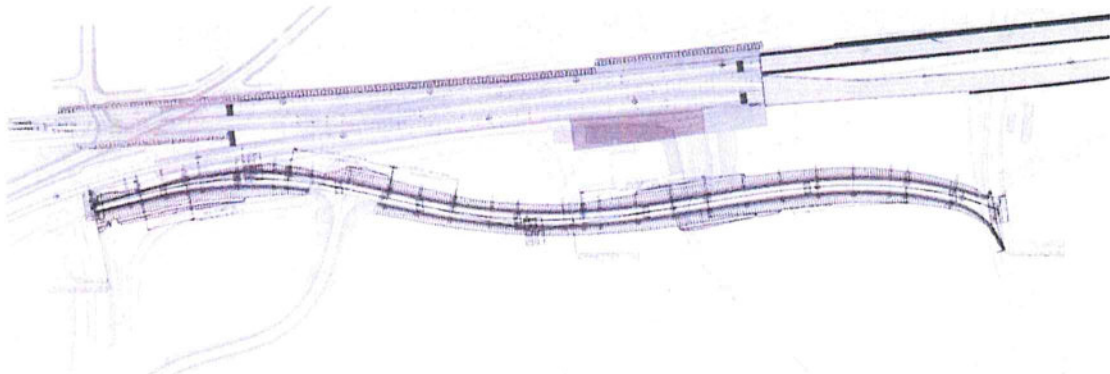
Stralcio planimetrico su rilievo Via della Spianà temporanea.
